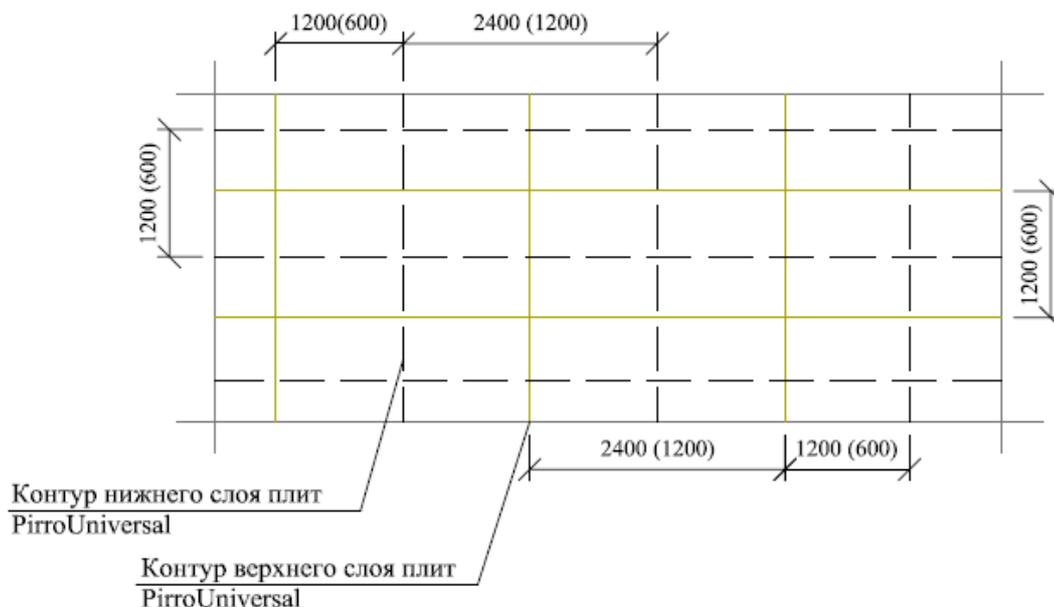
Схема раскладки плит PIRRO в два слоя поверх стропил
